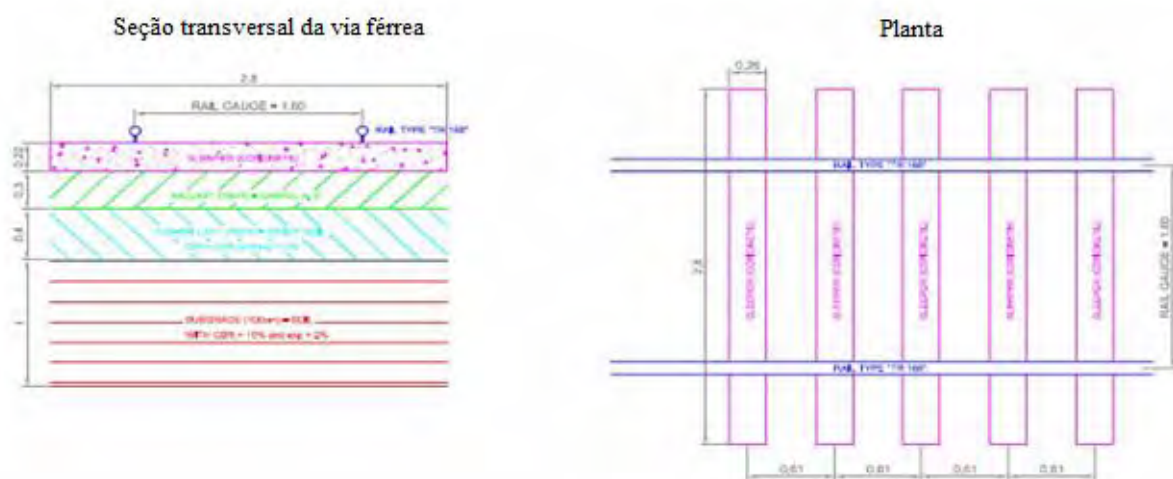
Seção da ferrovia em estudo e planta baixa da mesma.
